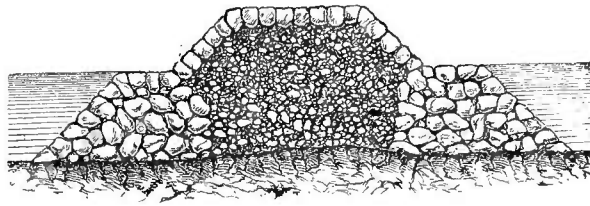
Section d'un épi à double banquette en pierres, avec blocaille.
